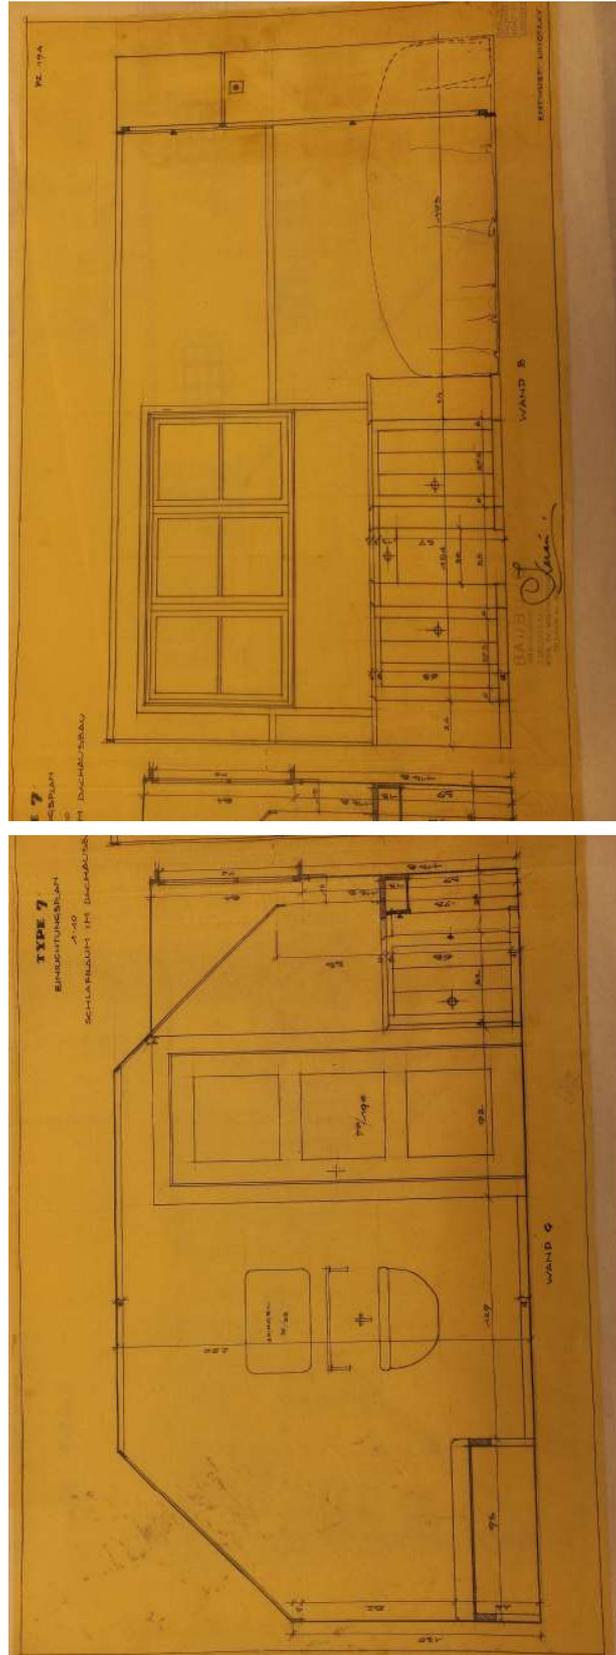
Abb.XIX:Kernhaus Type 7, Einrichtung Schlafzimmer im ausgebauten Dachraum. Wand C und Wand B.
